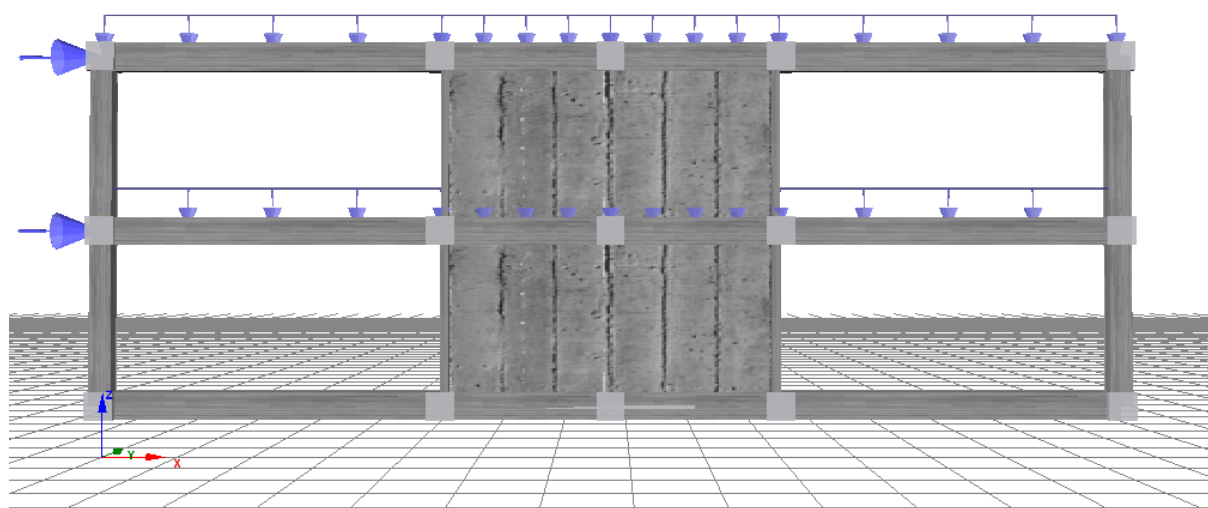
Estrutura reforçada com a adição de uma parede resistente de betão armado.
